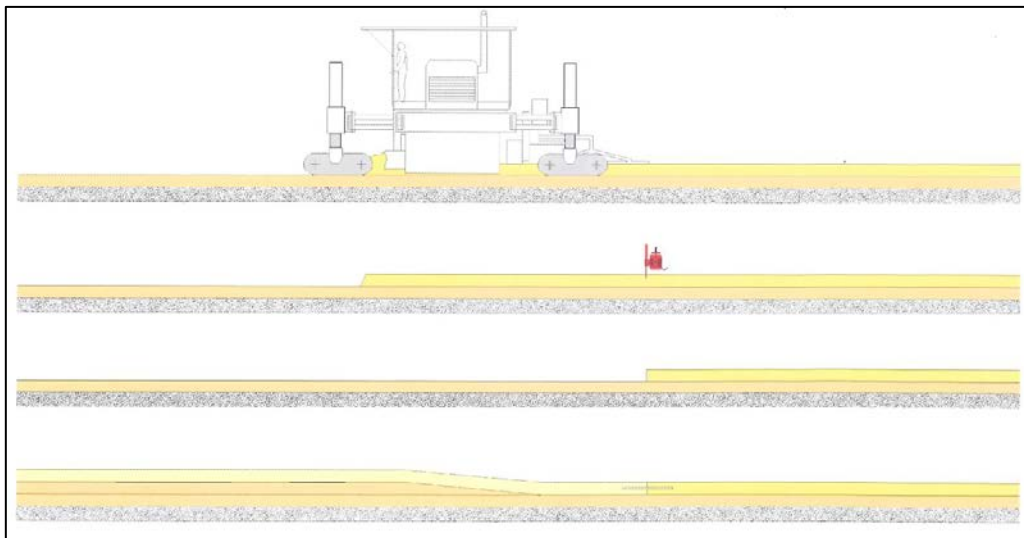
Construction homogène d'un plateau en béton coulé en place
